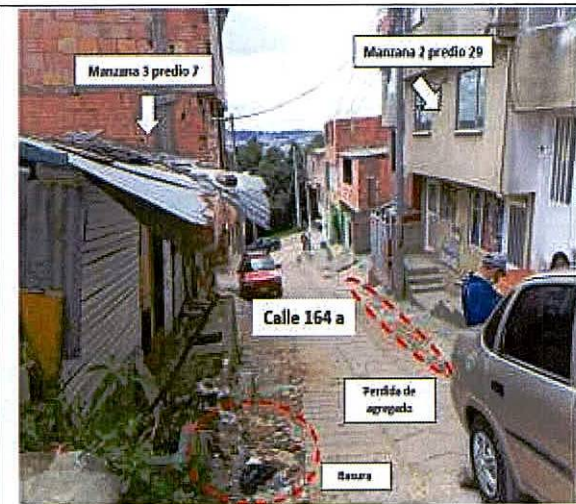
Vista Calle 164 con daños en el pavimento como pérdida de agregado.
